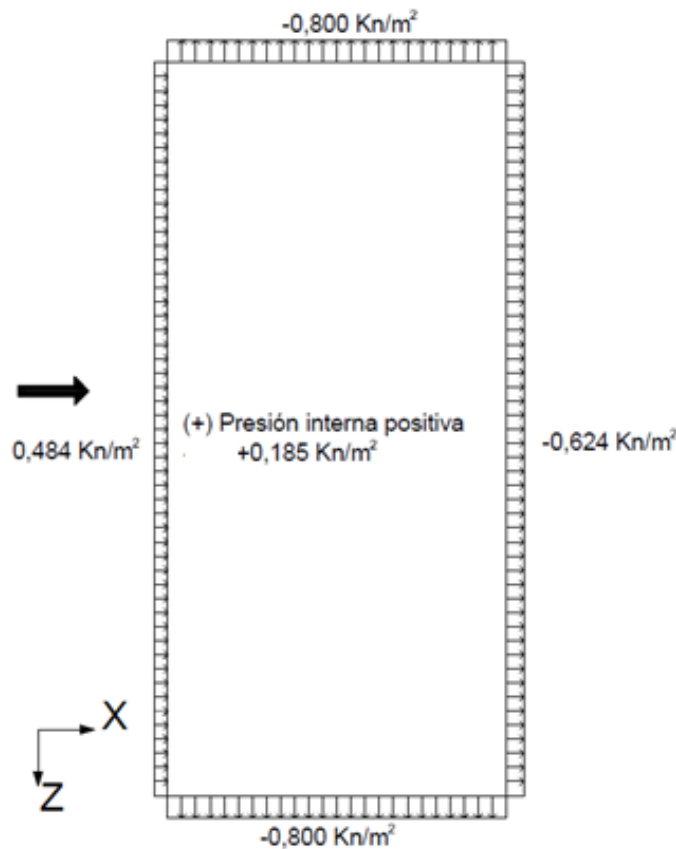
Vista en planta-Presiones de viento en la estructura
